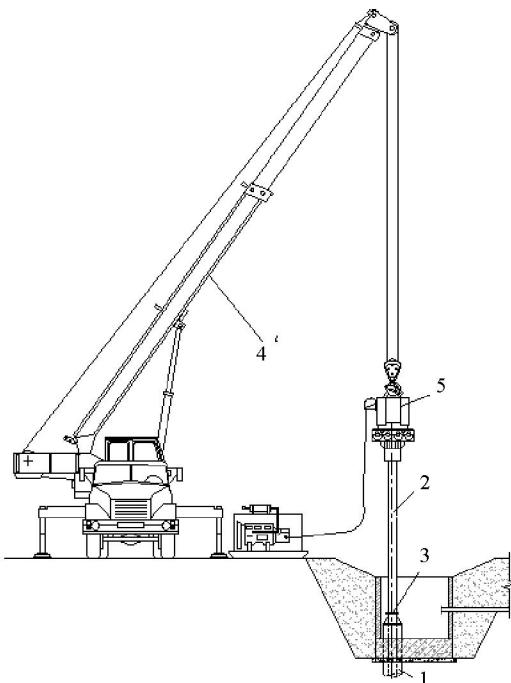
Схема извлечения фильтра скважины на обсадных трубах с помощью вибропогружателя «Мюллер» фирмы KRUPP HENDEL и грузоподъемного крана: 1 – обсадная труба; 2 – труба с фланцем; 3 – фланцевое соединение; 4 – грузоподъемный кран; 5 – вибропогружатель
